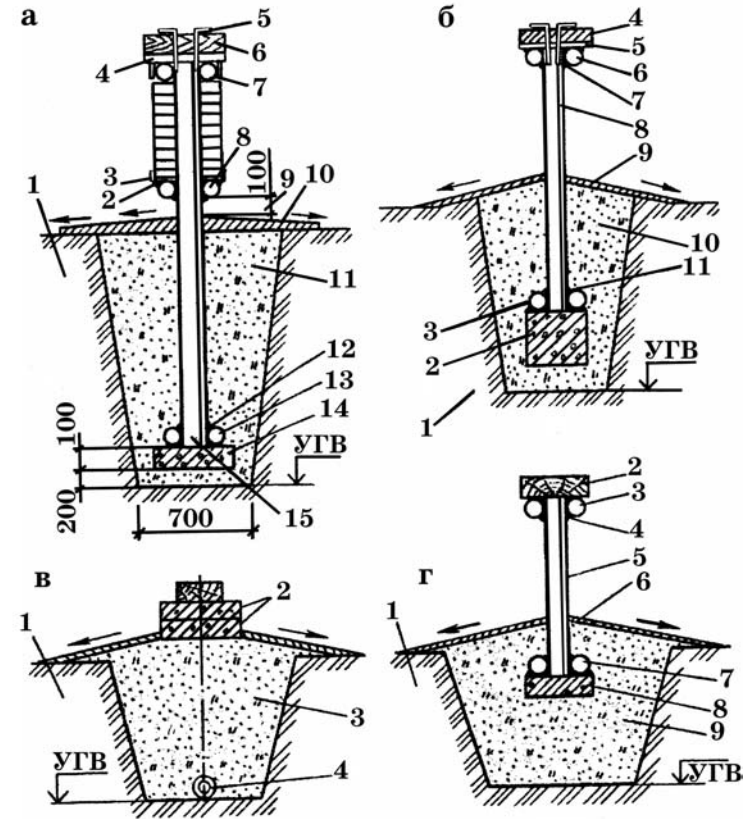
Варианты конструкций мелкозаглубленных фундаментов: а — столбчатый с кирпичной облицовкой: 1 — грунт основания; 2, 12 — сварка; 3 — уголок 40х40х5 мм, длиной 2 м; 4 — стальная плита размером 40х40х1 см; 5 — анкер; 6 — обвязка дома; 7 — труба диаметром 55 мм, длиной 50 см; 8, 13 — трубы диаметром 55 мм, длиной 50 см; 9 — просвет; 10 — отмостка; 11 — песок; 14 — опорная плита размером 50х50х10 см; 15 — труба диаметром 100 мм; б — столбчатый без облицовки: 1 — грунт основания; 2 — железобетонный блок-свая размером 30х30; 3, 6 — трубы диаметром 50 мм, длиной 50 см; 7, 11 — сварка; 8 — труба диаметром 100 мм; 9 — отмостка; 10 — песок; в — ленточный с дренажной трубой: 1 — грунт основания; 2 — обвязка дома; 3 — песок; 4 — труба диаметром 50 мм, длиной 50 см; г : 1 — грунт основания; 2 — обвязка дома; 3, 7 — труба диаметром 50 мм, длиной 50 см; 4 — сварка; 5 — трубы диаметром 100 мм, длиной 1,2 м; 6 — отмостка; 8 — опорная железобетонная плита; 9 — песок.
